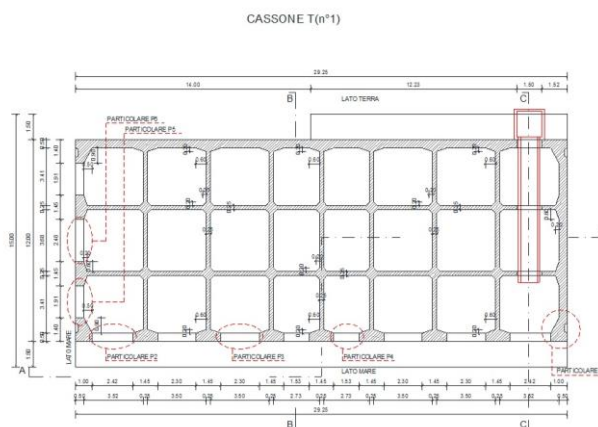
pianta carpenteria (008 049 00SD) disposizione interna celle cassone T pos.12
